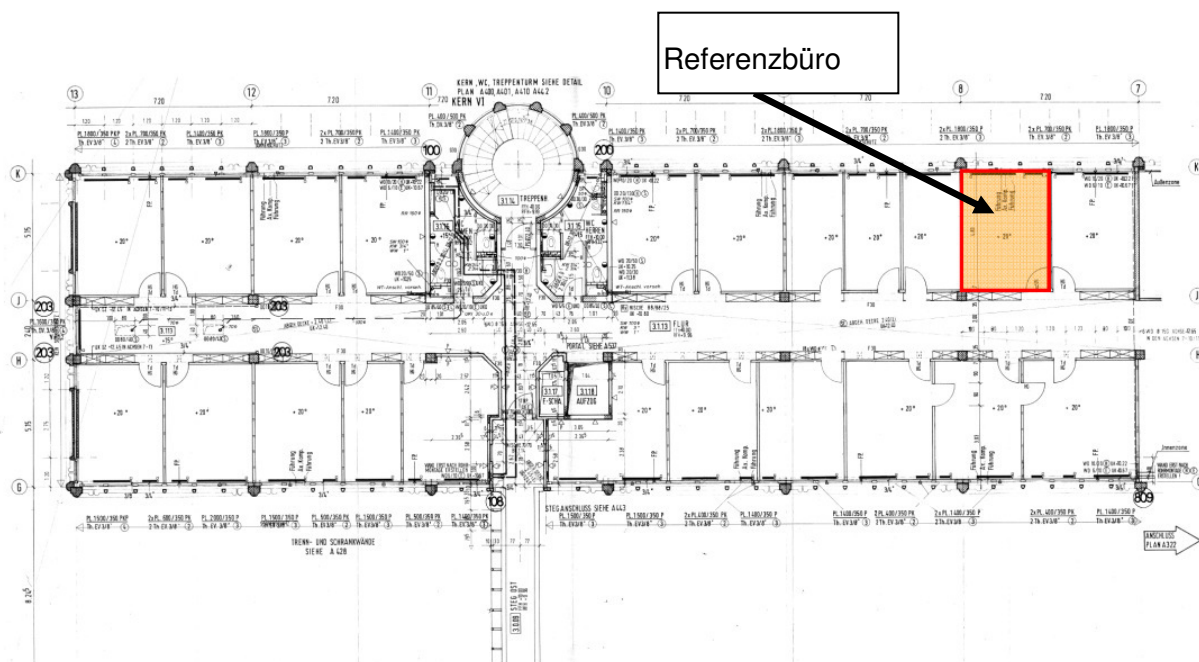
22 Referenzbüro im Grundriss
